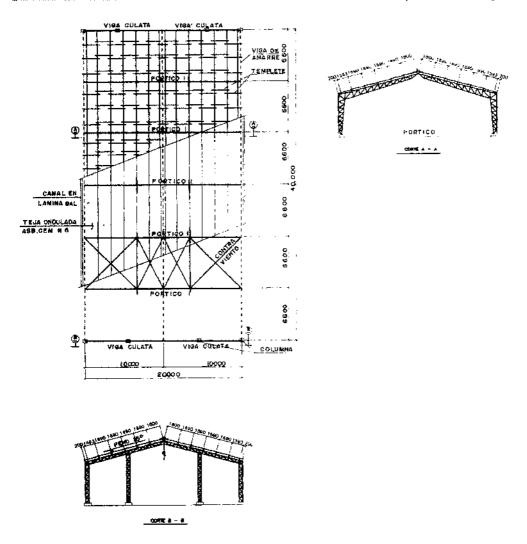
Planta general de cubierta y cortes trasversales de la bodega industrial, alternativa con pórticos triarticulados.
